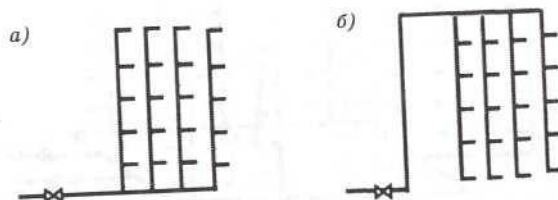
Схема тупикового водопровода: а – с нижней разводкой; б – с верхней разводкой
